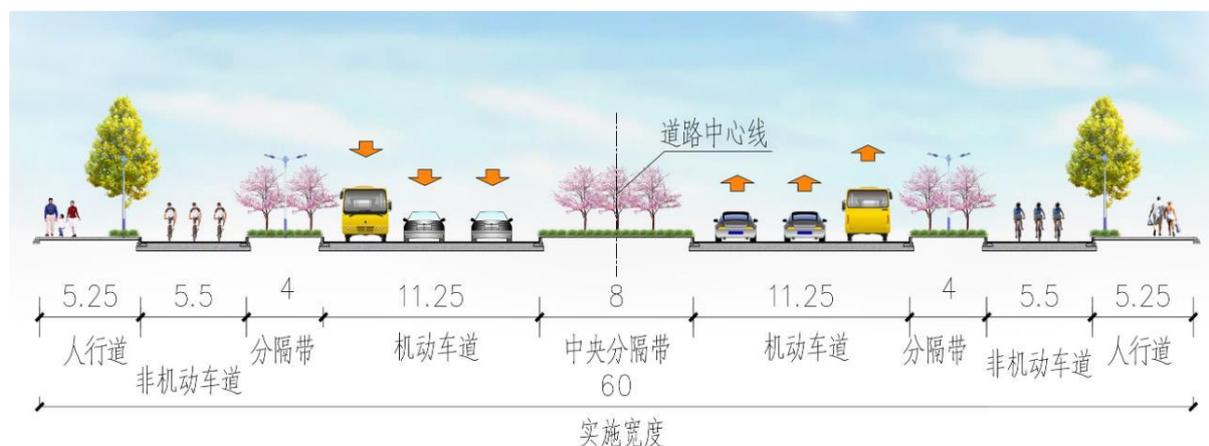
(a) 春兰路 (姜高路-海军大道段) 地面道路标准段横断面布置图
